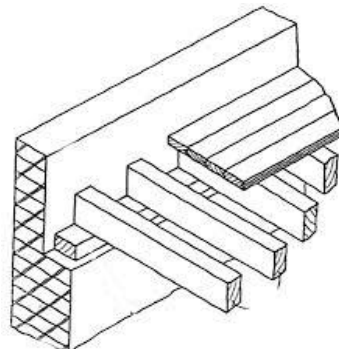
Ouverture d'une trémie dans un plancher en bois. [44]
